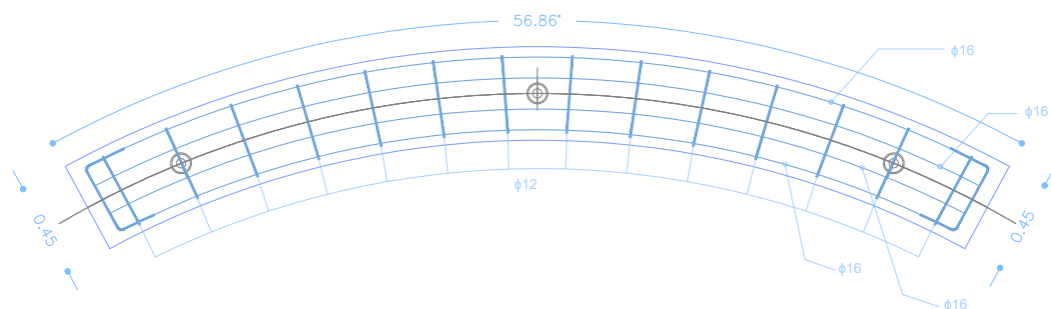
Plano Dovela – Armadura Sección Transversal – Dirección Longitudinal
